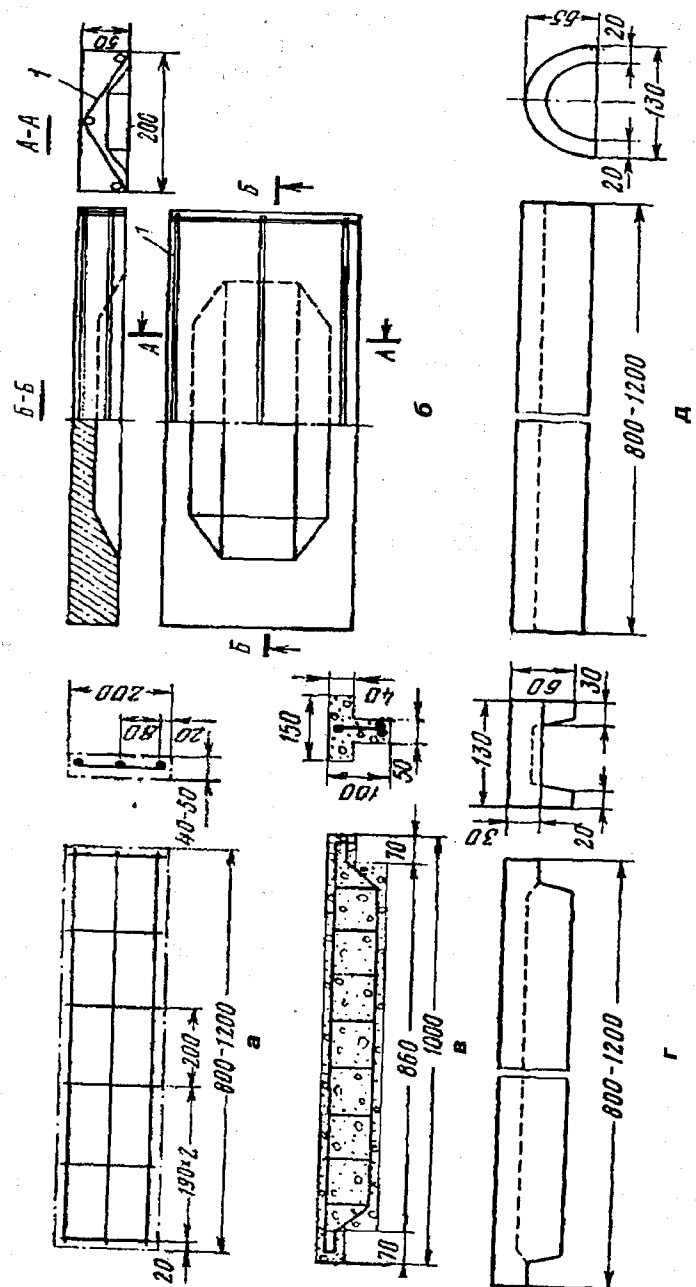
Конструкции железобетонных затяжек: а — плоская; б — кессонная; в — тавровая; г, д — фасонные
